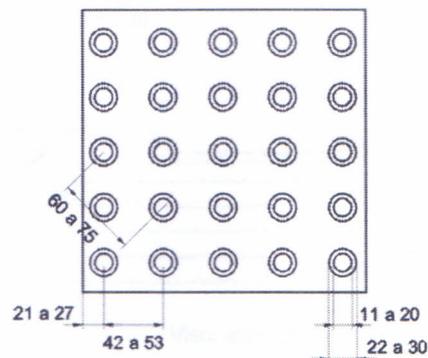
Sinalização tátil de alerta – Modulação do piso
